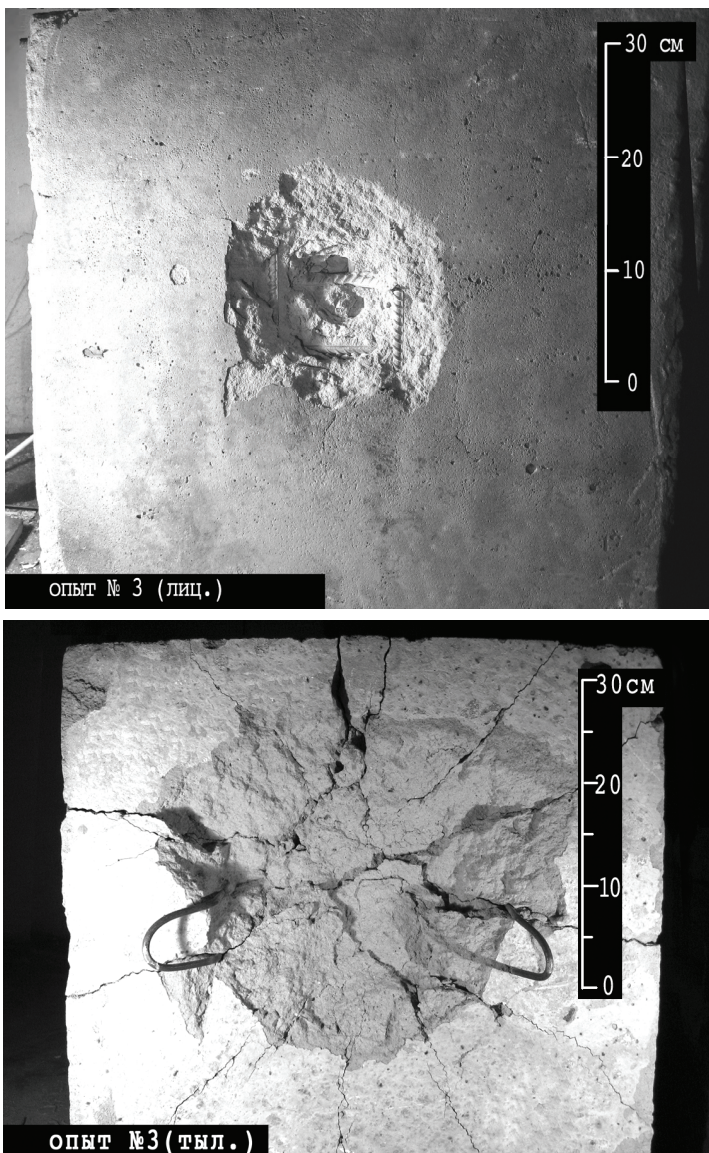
Завершенное откольное разрушение железобетонной плиты толщиной 200 мм при ударе алюминиевым бойком калибром 50 мм. Верхнее фото – лицевая сторона плиты. Нижнее фото – тыльная сторона плиты. Скорость удара 520 м/с
